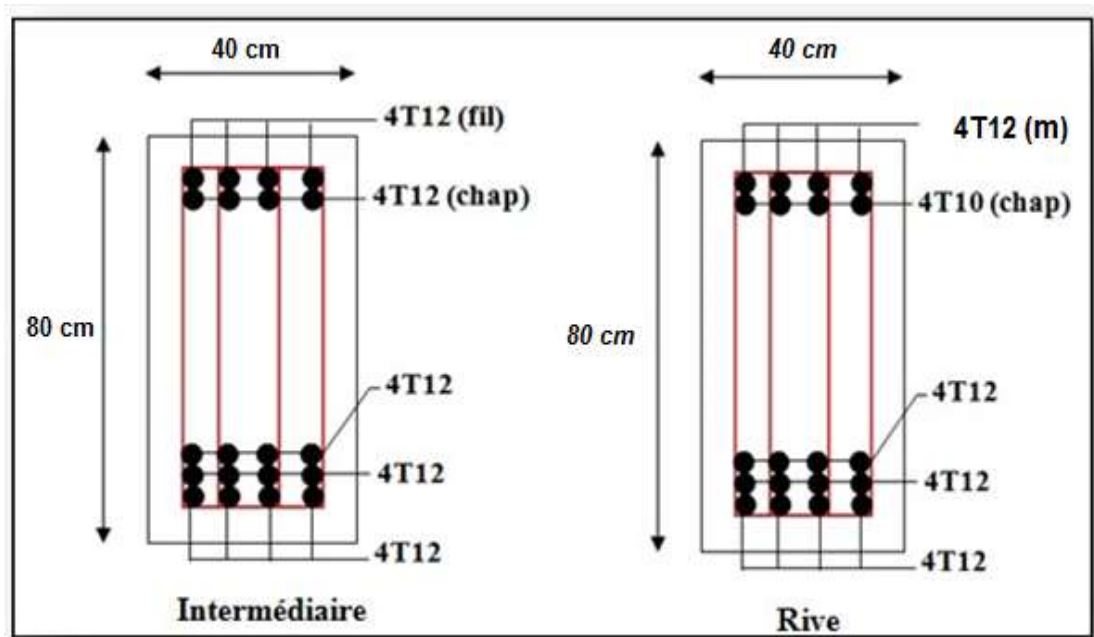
Ferrailage de la poutre de libage suivant le sens transversale.
